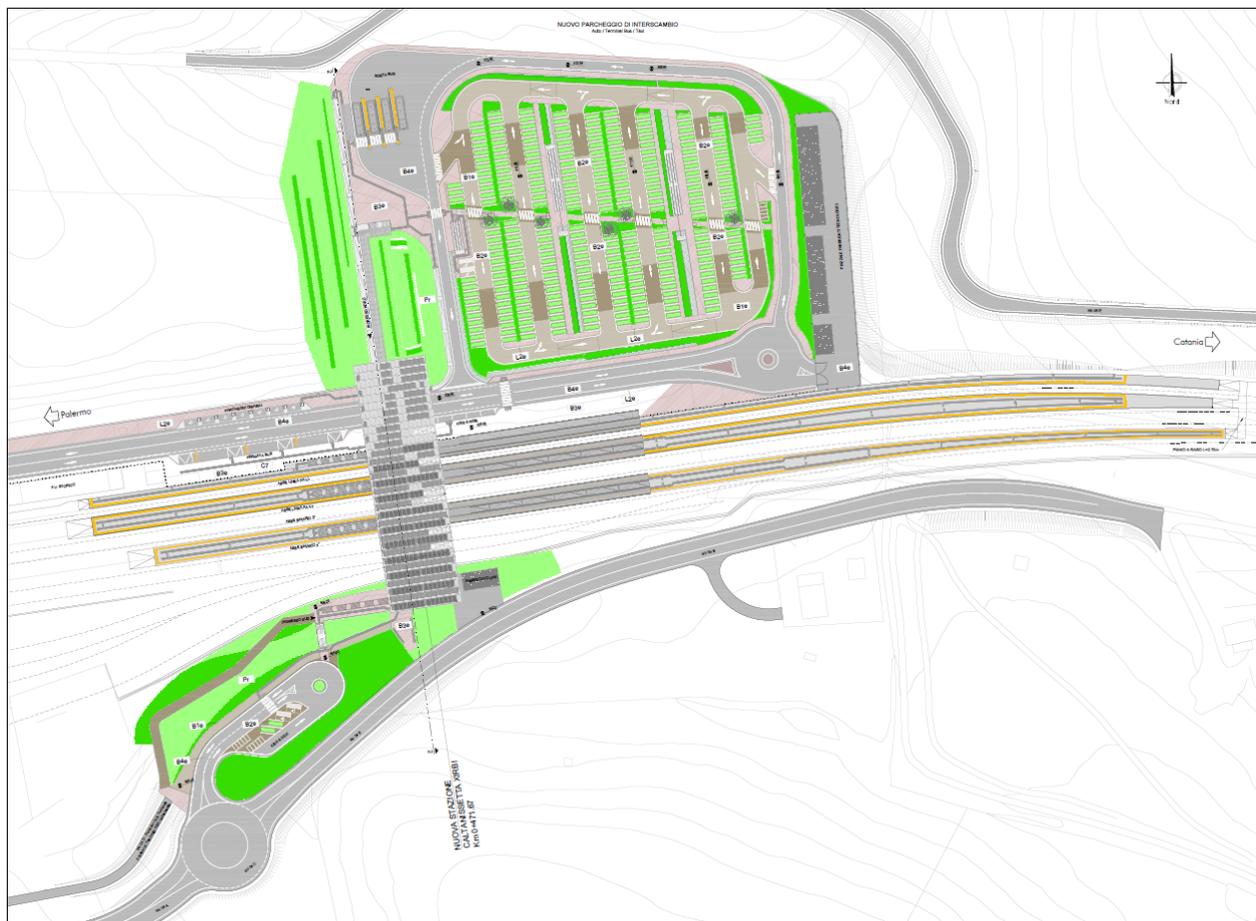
Stazione Caltanissetta Xirbi - Planimetria assetto generale
